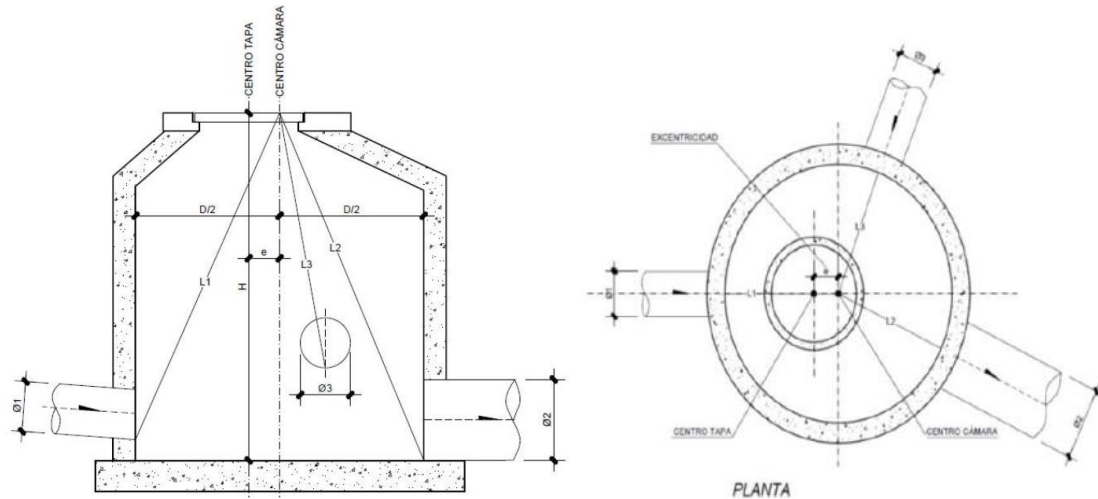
Vista en altura y planta del levantamiento directo de una cámara concéntrica.
